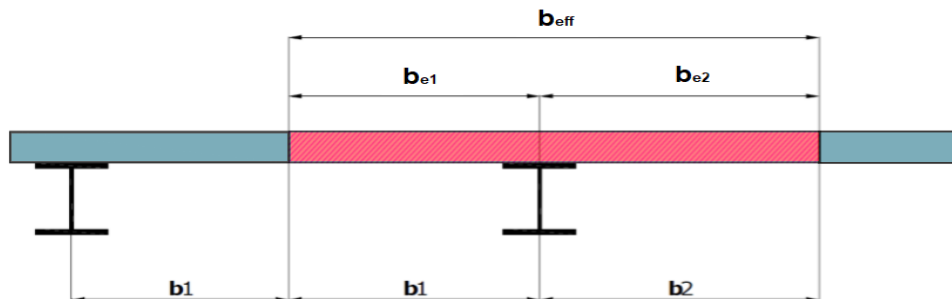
Largeur participante de dalle pour une poutre de plancher
